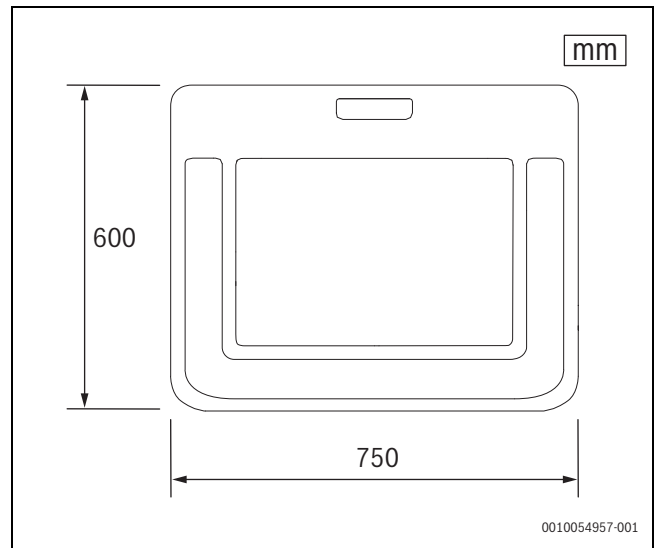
Dimensions des pièces latérales de la fondation préfabriquée
